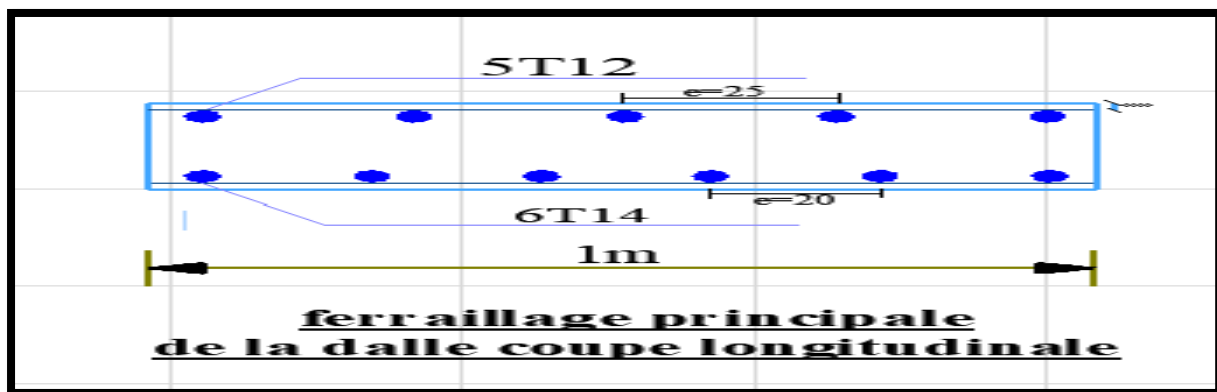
Ferrailage principale de la dalle coupe longitudinale du tablier
